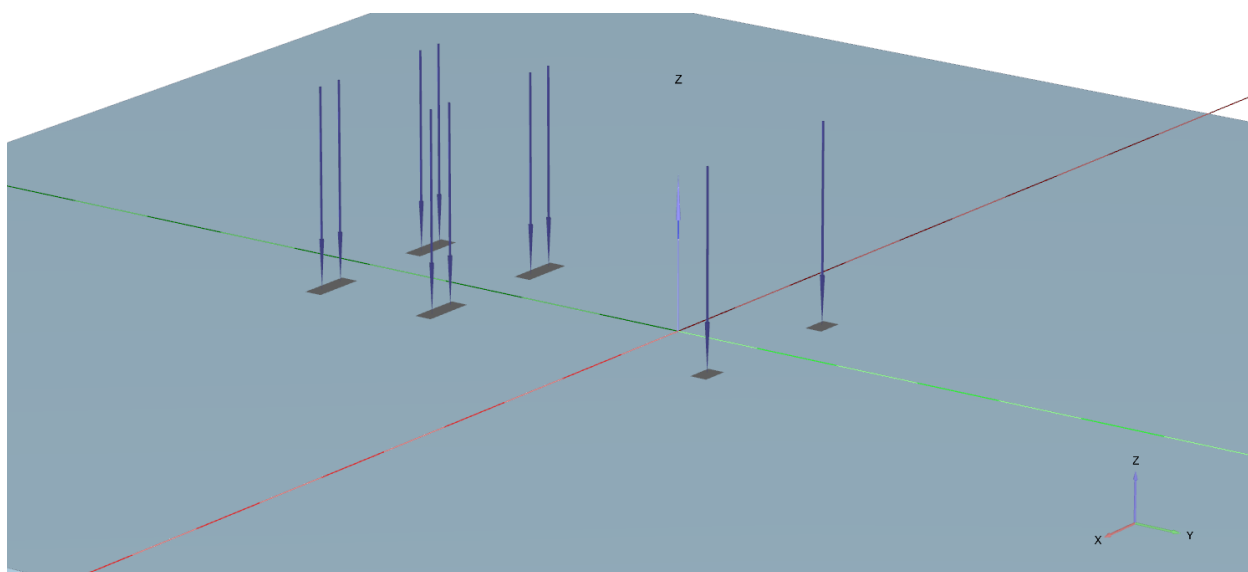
Расчетная схема приложения нагрузки от самосвала Камаз 6520
